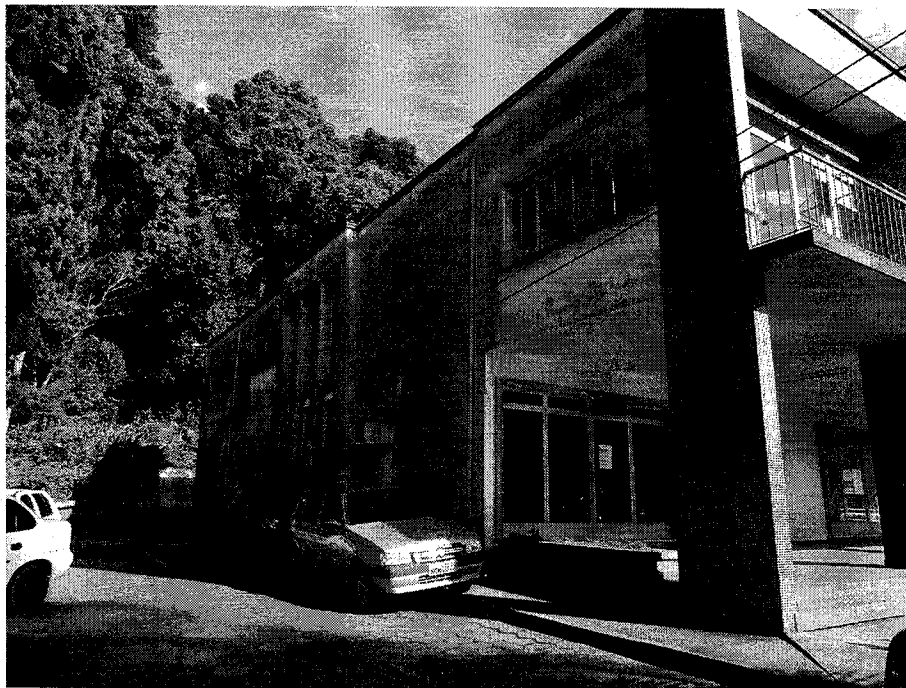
Fachada lateral esquerda – Reboco e pintura danificados
